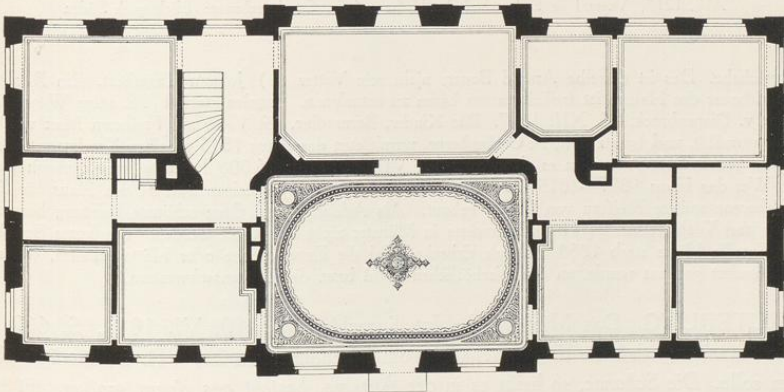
Grundriß des zweiten Geschosses. Maßstab 1 : 200
